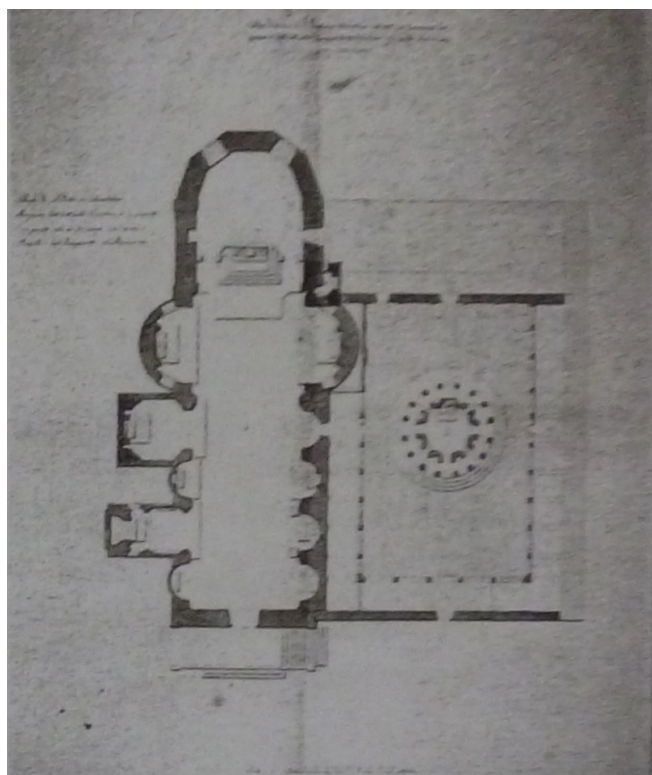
V. Vespignani, pianta della chiesa e del chiostro 1870
